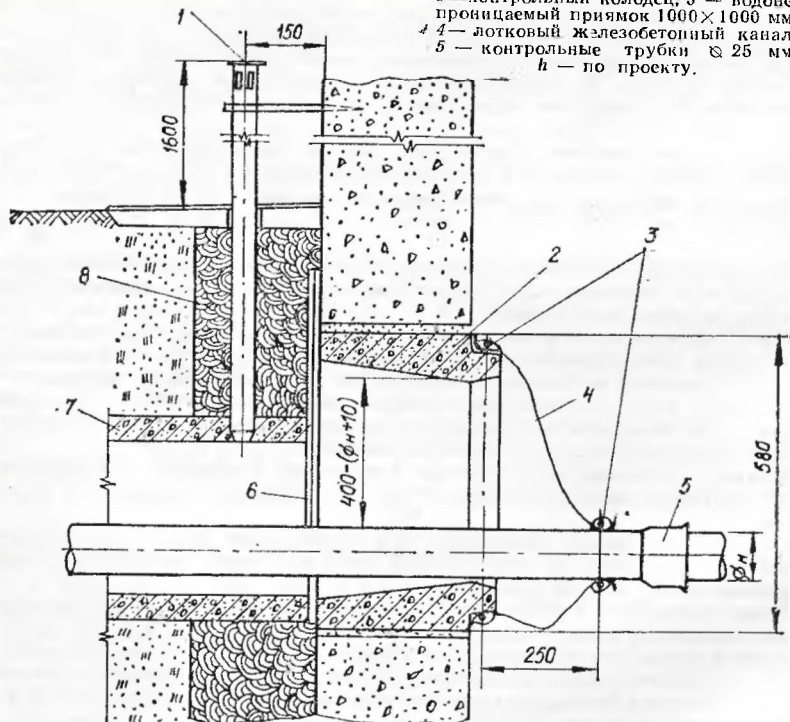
Выпуск канализации из здания, сооруженного на просадочных грунтах:
